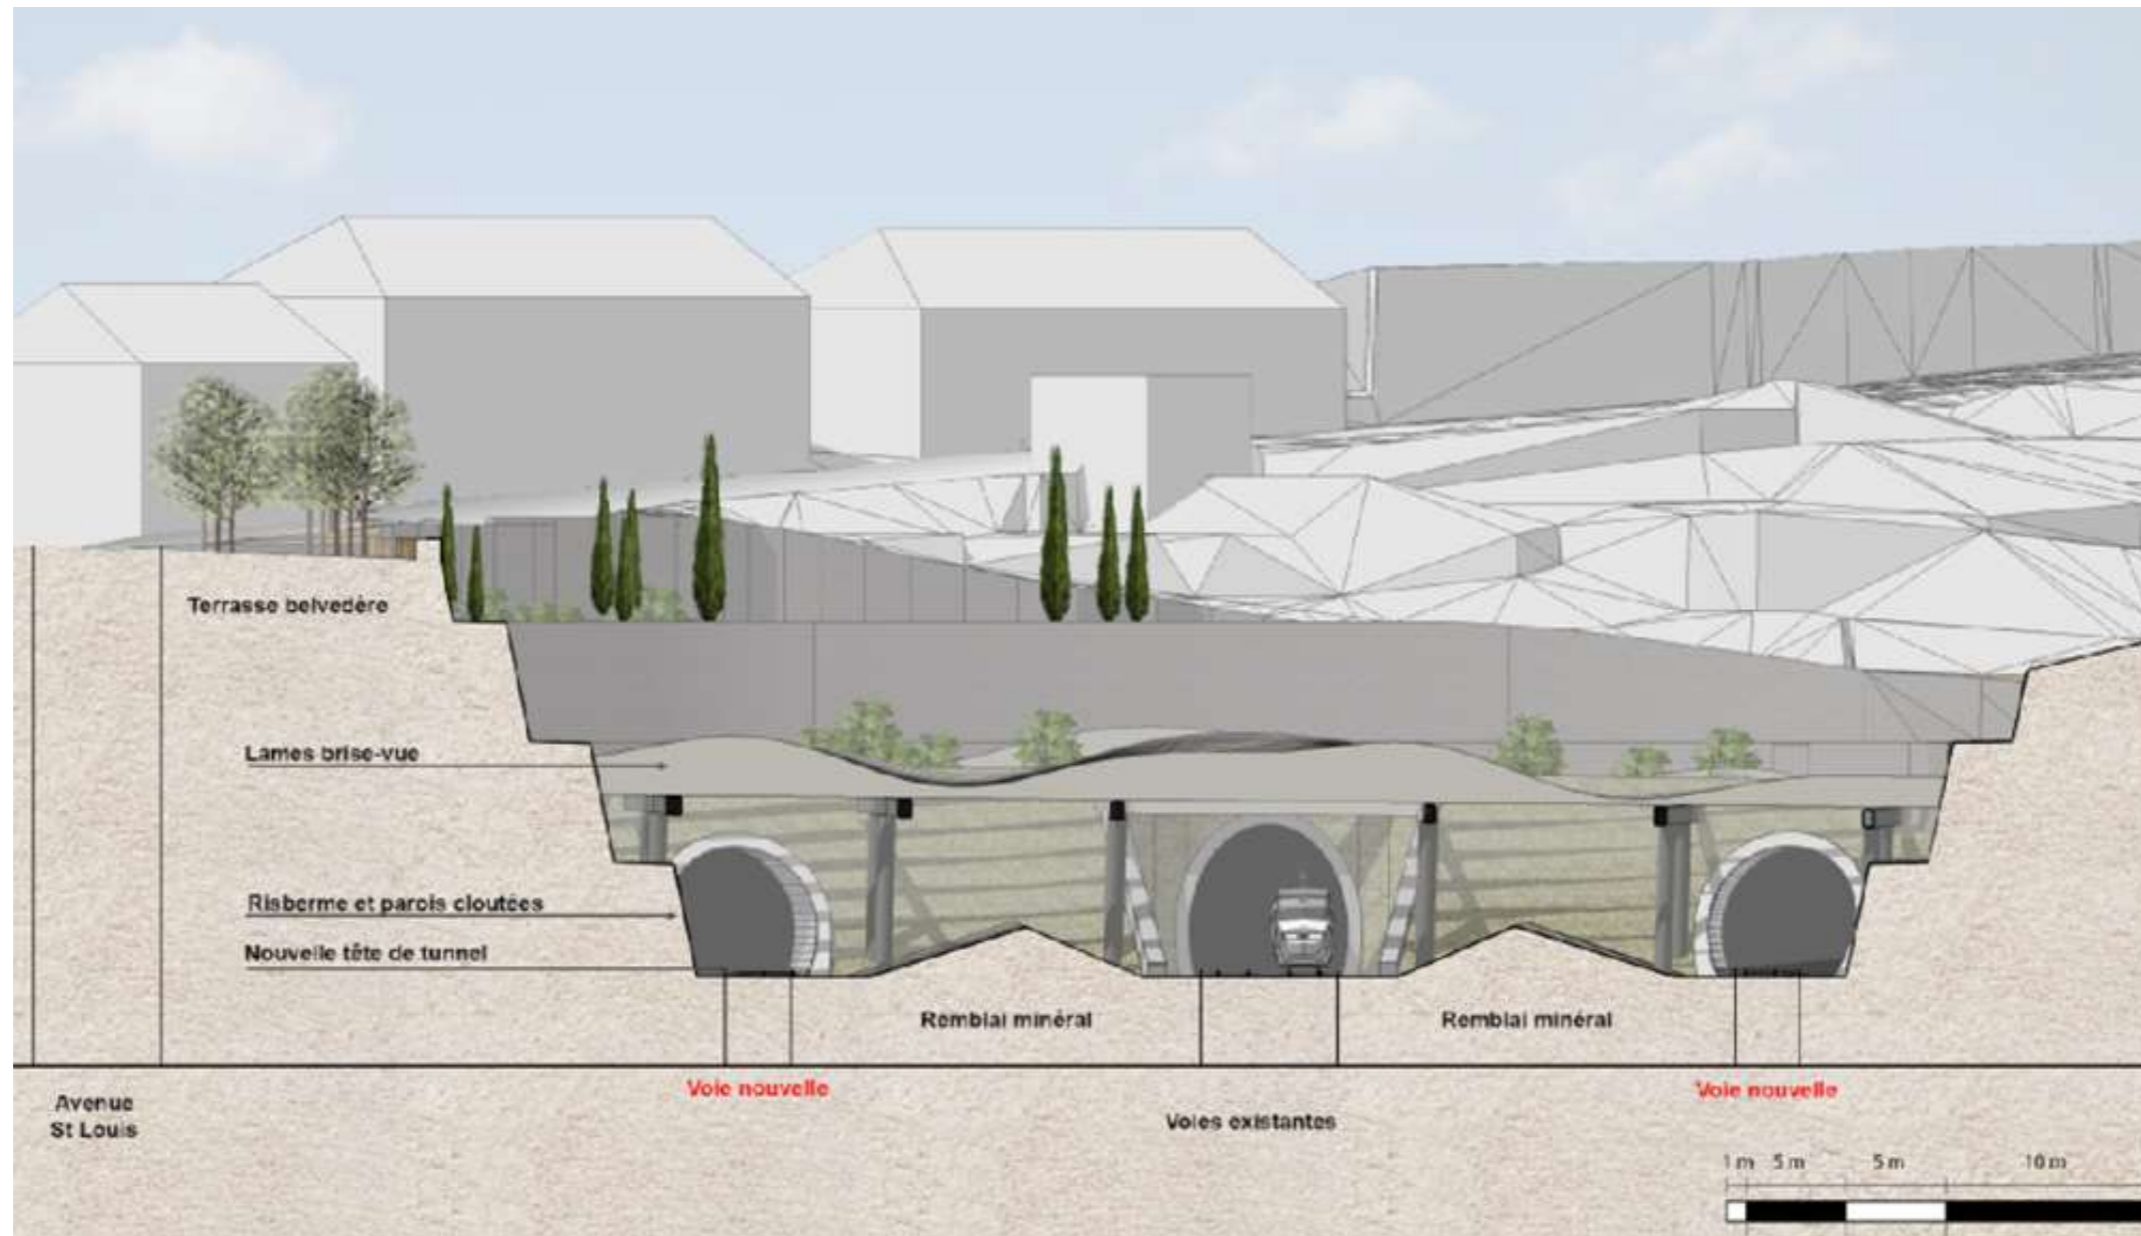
Exemple de mesure - Coupe paysagère sur les têtes de tunnels (Egis, 2021)
